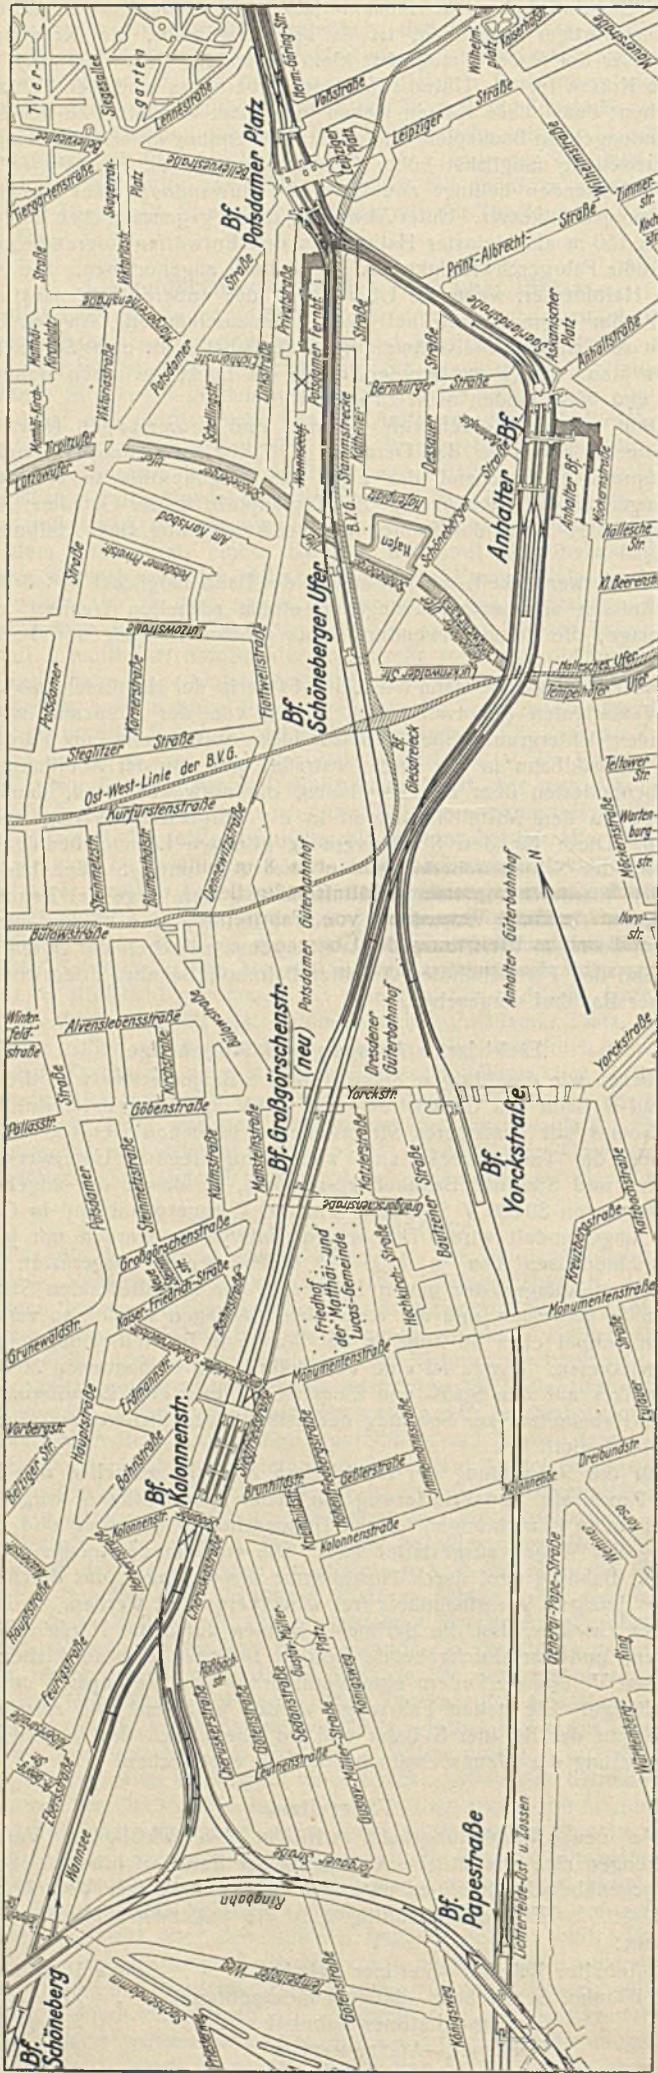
Lageplan Abschnitt Bahnhof Schönberg—Lennéstraße.
